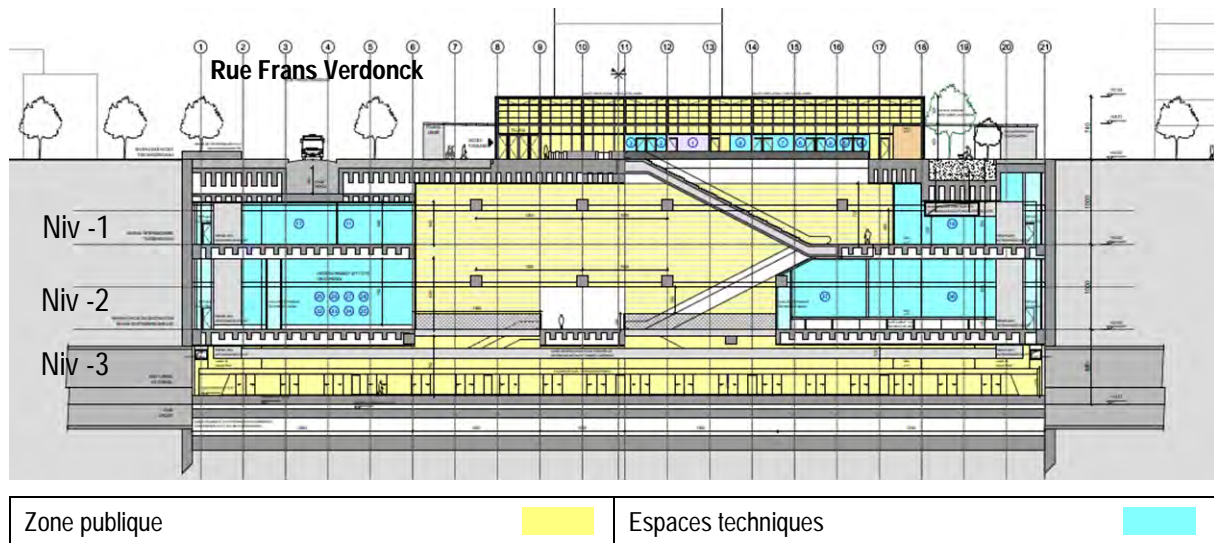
Station Tilleul, coupe longitudinale (BMN, 2018)
